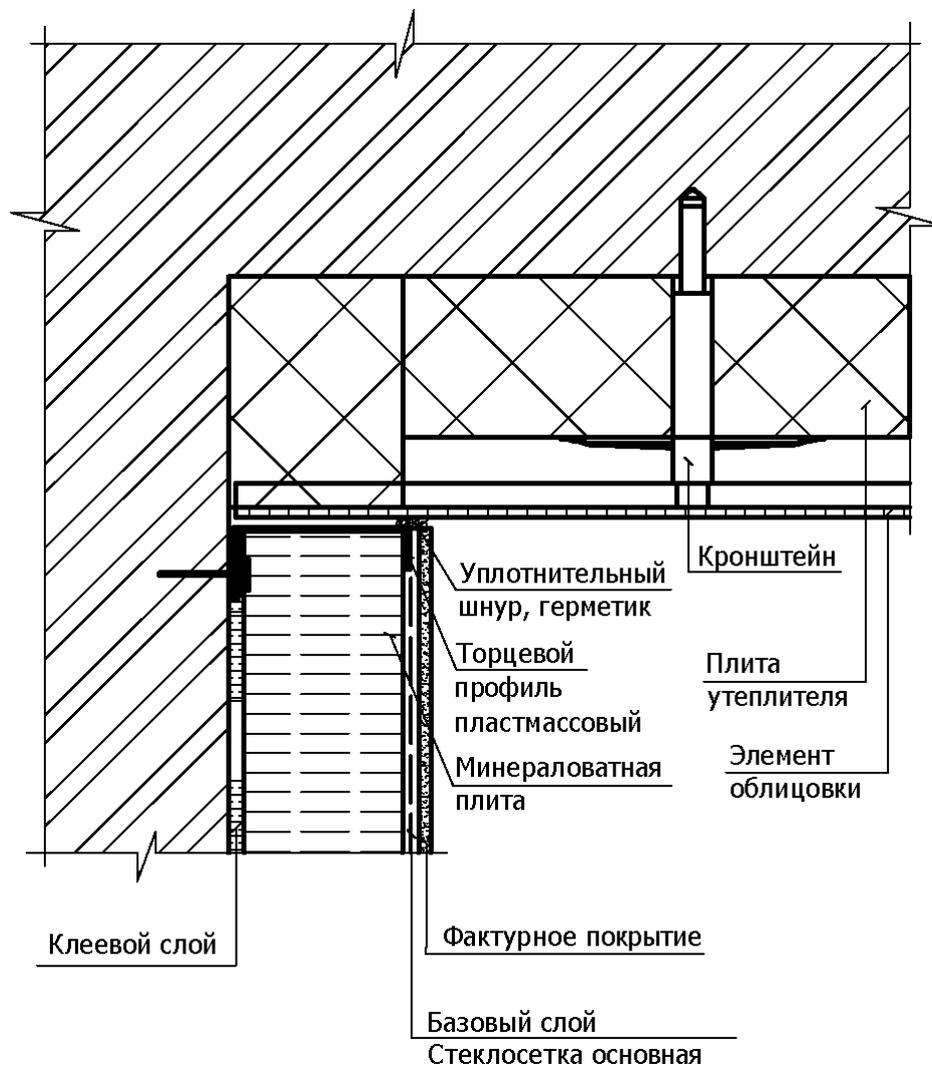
П Примыкание системы к вентилируемому фасаду на внутренних углах (вариант 3) ЛАЭС-П
